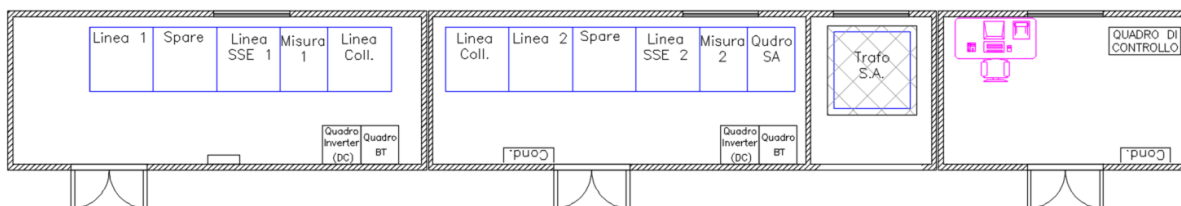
Quadro di Raccolta e Misura: Zona 1, Planimetria
